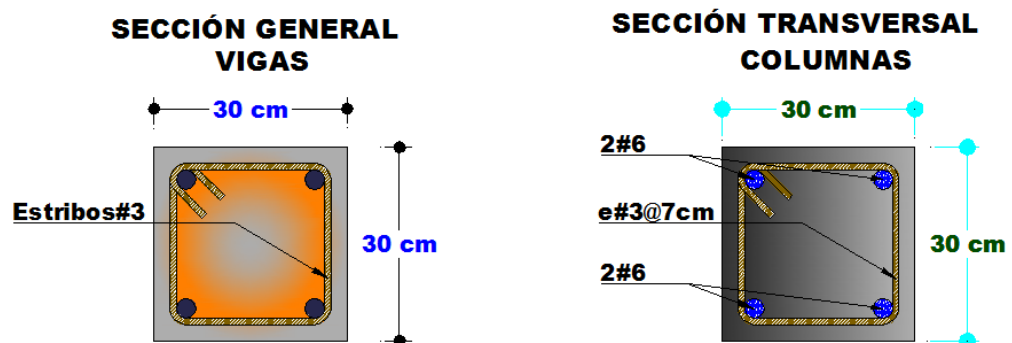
Secciones transversales de vigas y columnas usadas en la vivienda tipo 2.
